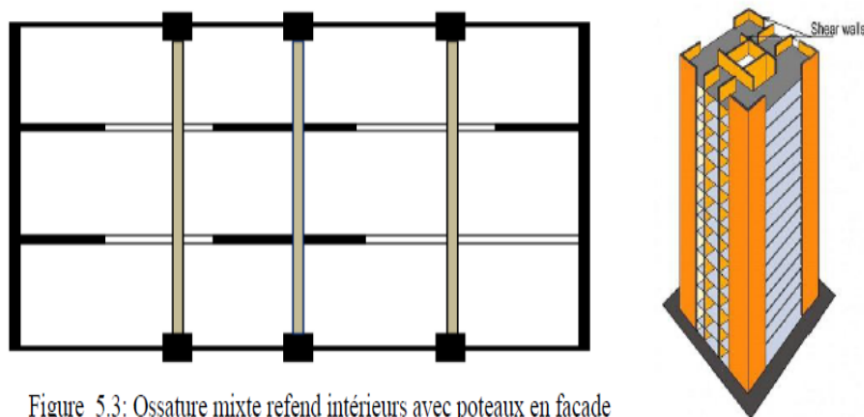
Ossature mixte refend intérieurs avec poteaux en façade
